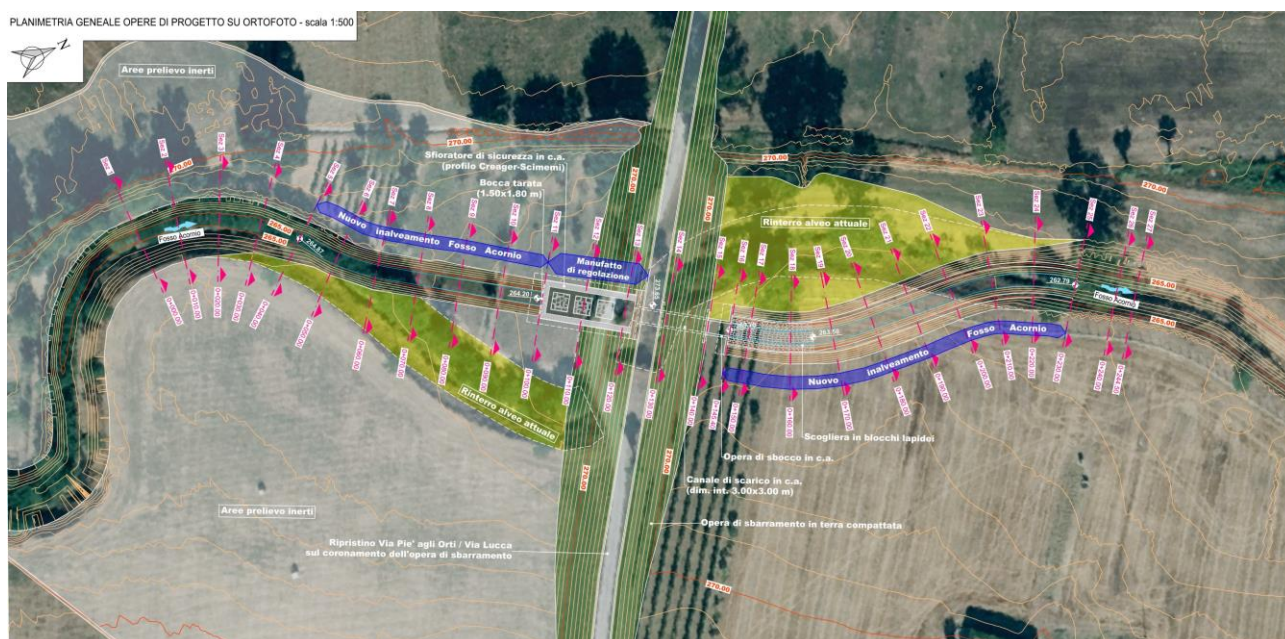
Planimetria progetto manufatto in c.a. con individuazione delle sezioni trasversali sul Fosso Acornio.
